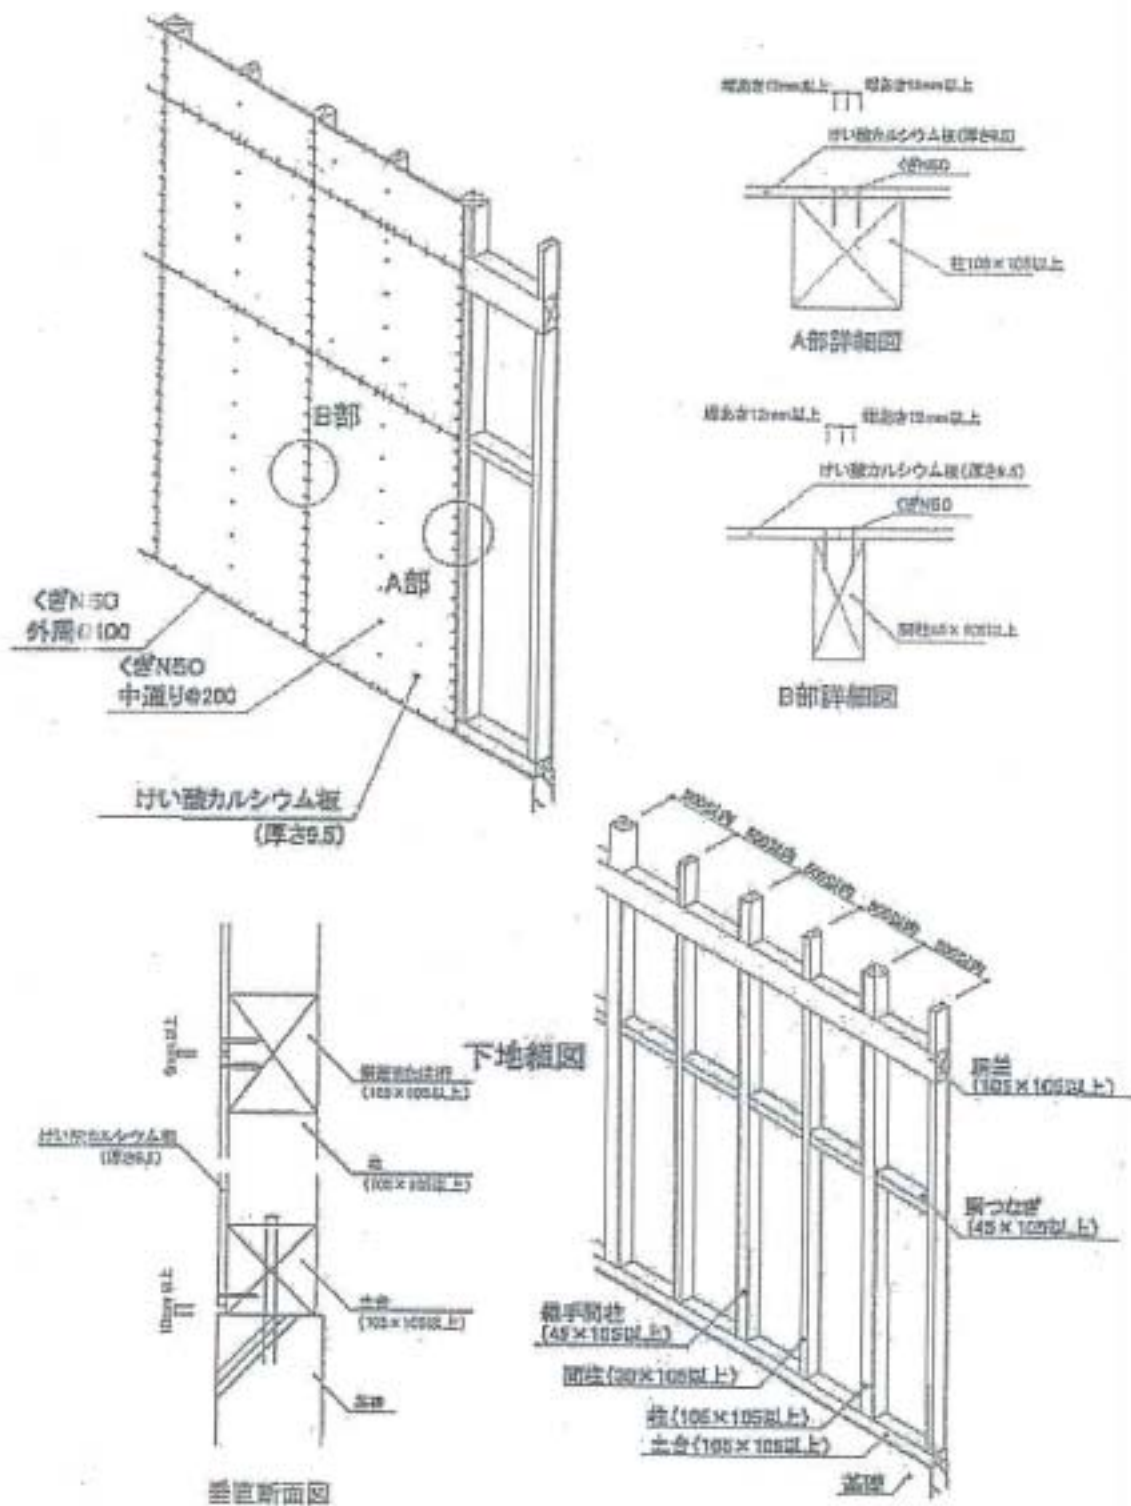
施工図：継手を設ける場合（寸法単位：mm）
